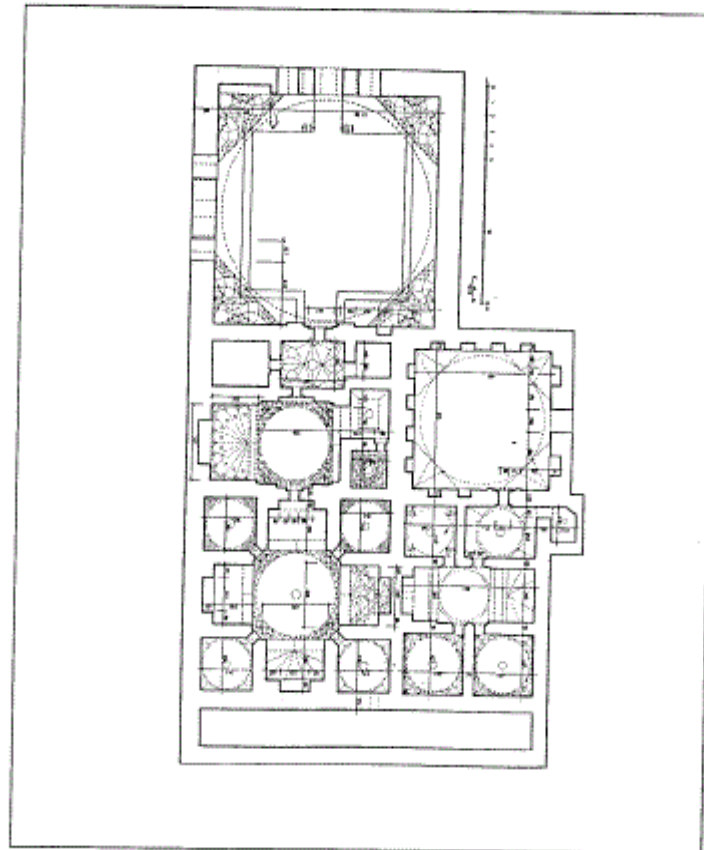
مسقط أفقي لعمارت ميخال أوغلو محمد بك في اهتمام بيلغاريا (عن :
